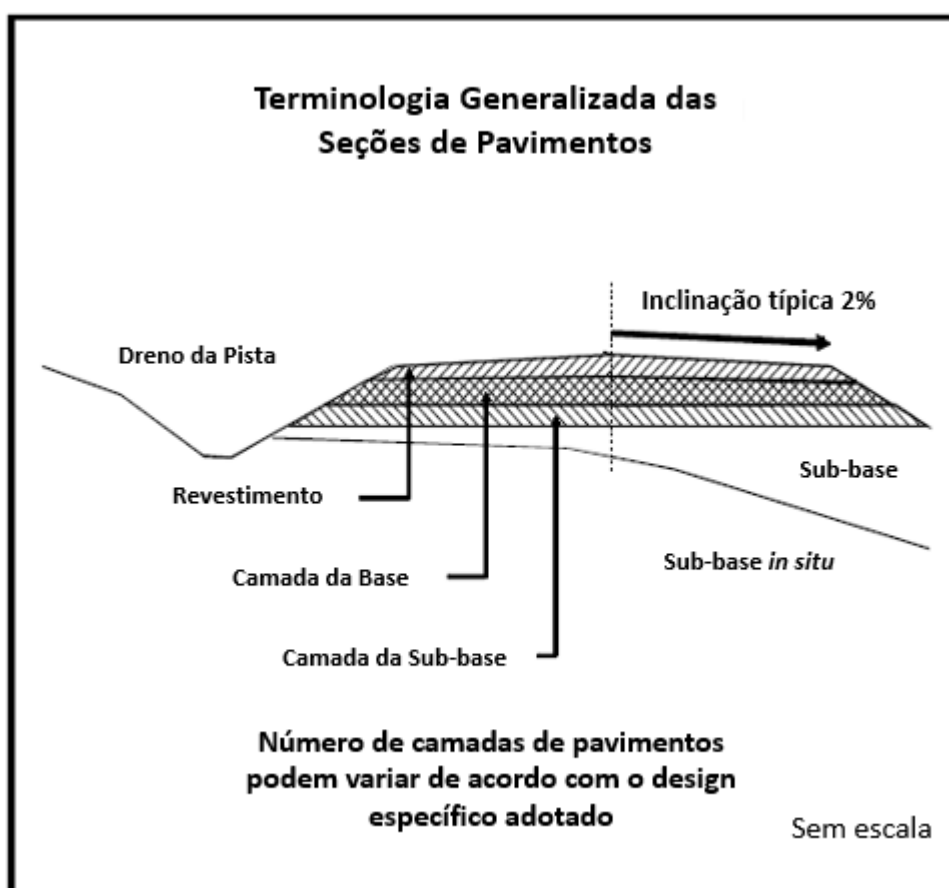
Distribuição das camadas do pavimento das estradas na mineração
